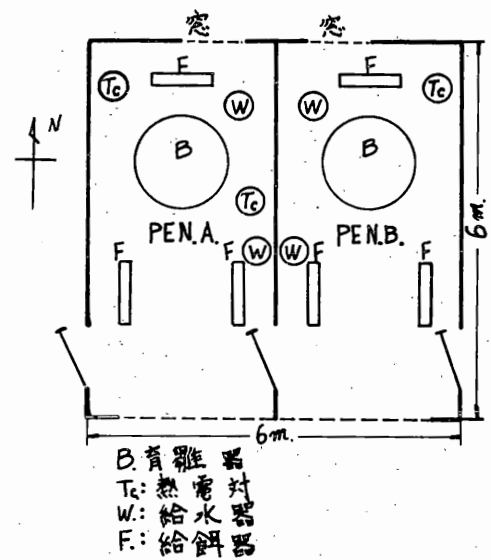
No.3 鶏舎の平面図 (他の鶏舎もこれに類似している)
